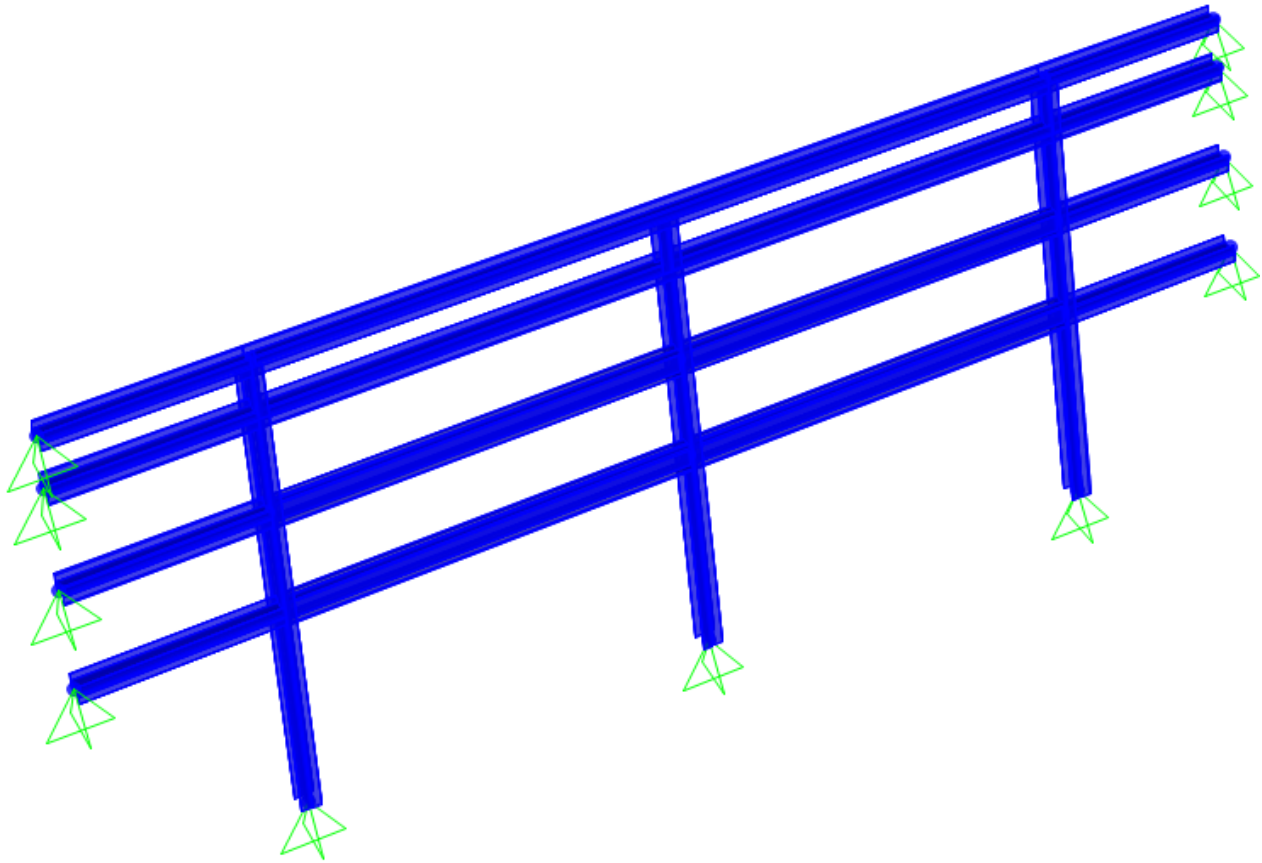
Modellazione della struttura portapannelli Filo 33 – Vista
